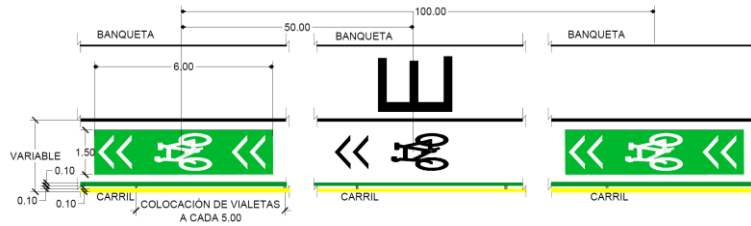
Detalle de señalamiento horizontal Tipo 3, manzanas mayores a 100m.
